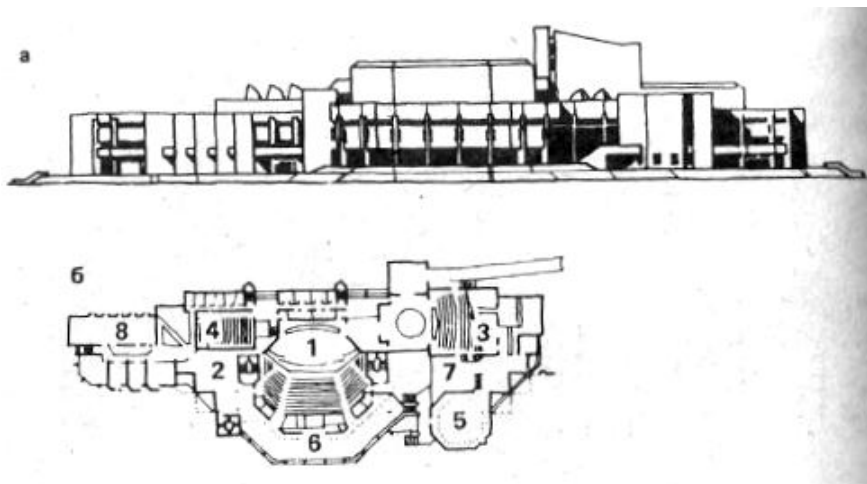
Будинок культури в Волгодонську ЦНПЕП ім. Б. С. Мезенцева. а – фасад, б – план першого поверху.
